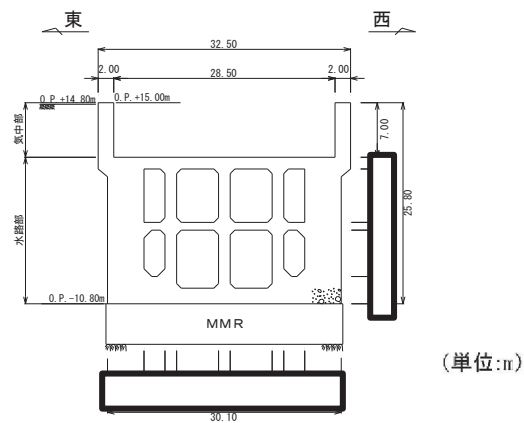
海水ポンプ室断面図 (A-A 断面, 東西 (スクリーンエリア))
